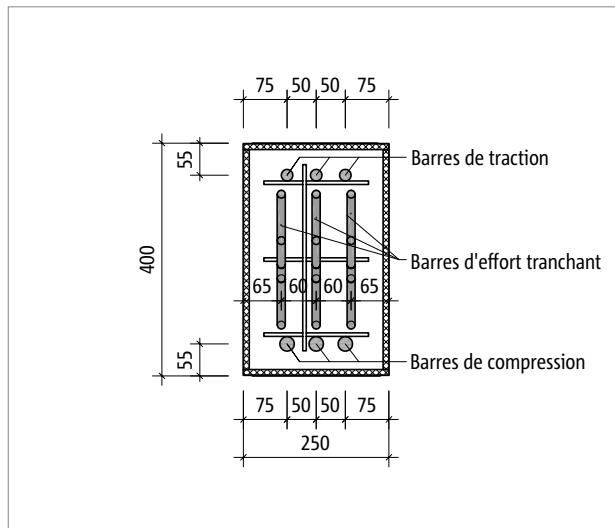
Schöck Isokorb® T Type B-M5-V1 en hauteur H400 : Vue du produit
